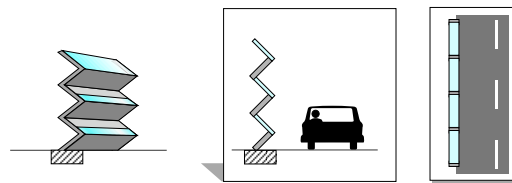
Typ 3 Zick-Zack. Die Module und die LSW ist in Zick Zack Form aufgebaut.
